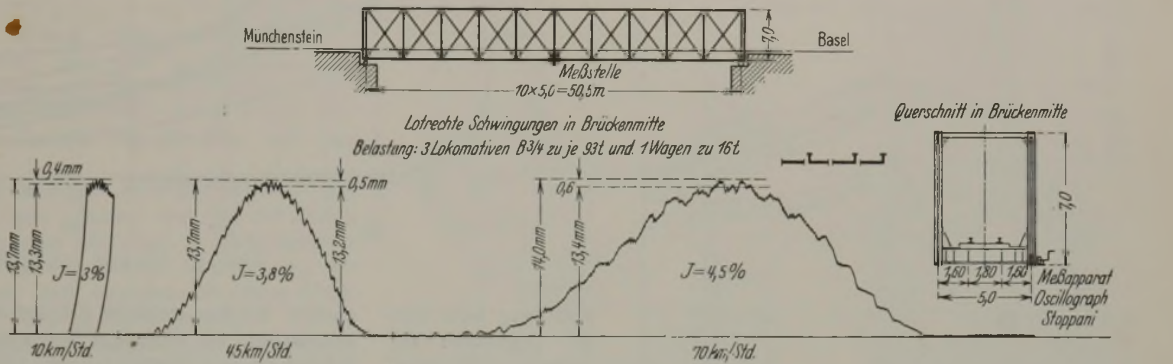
Schwingungen einer Eisenbahnbrücke.
